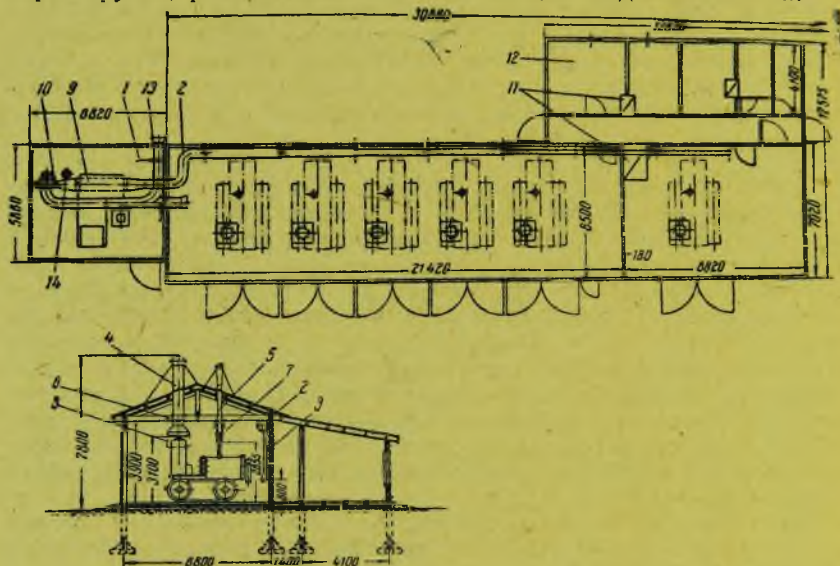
Схема приточно-отопительной вентиляции ЦНИИМЭ:
